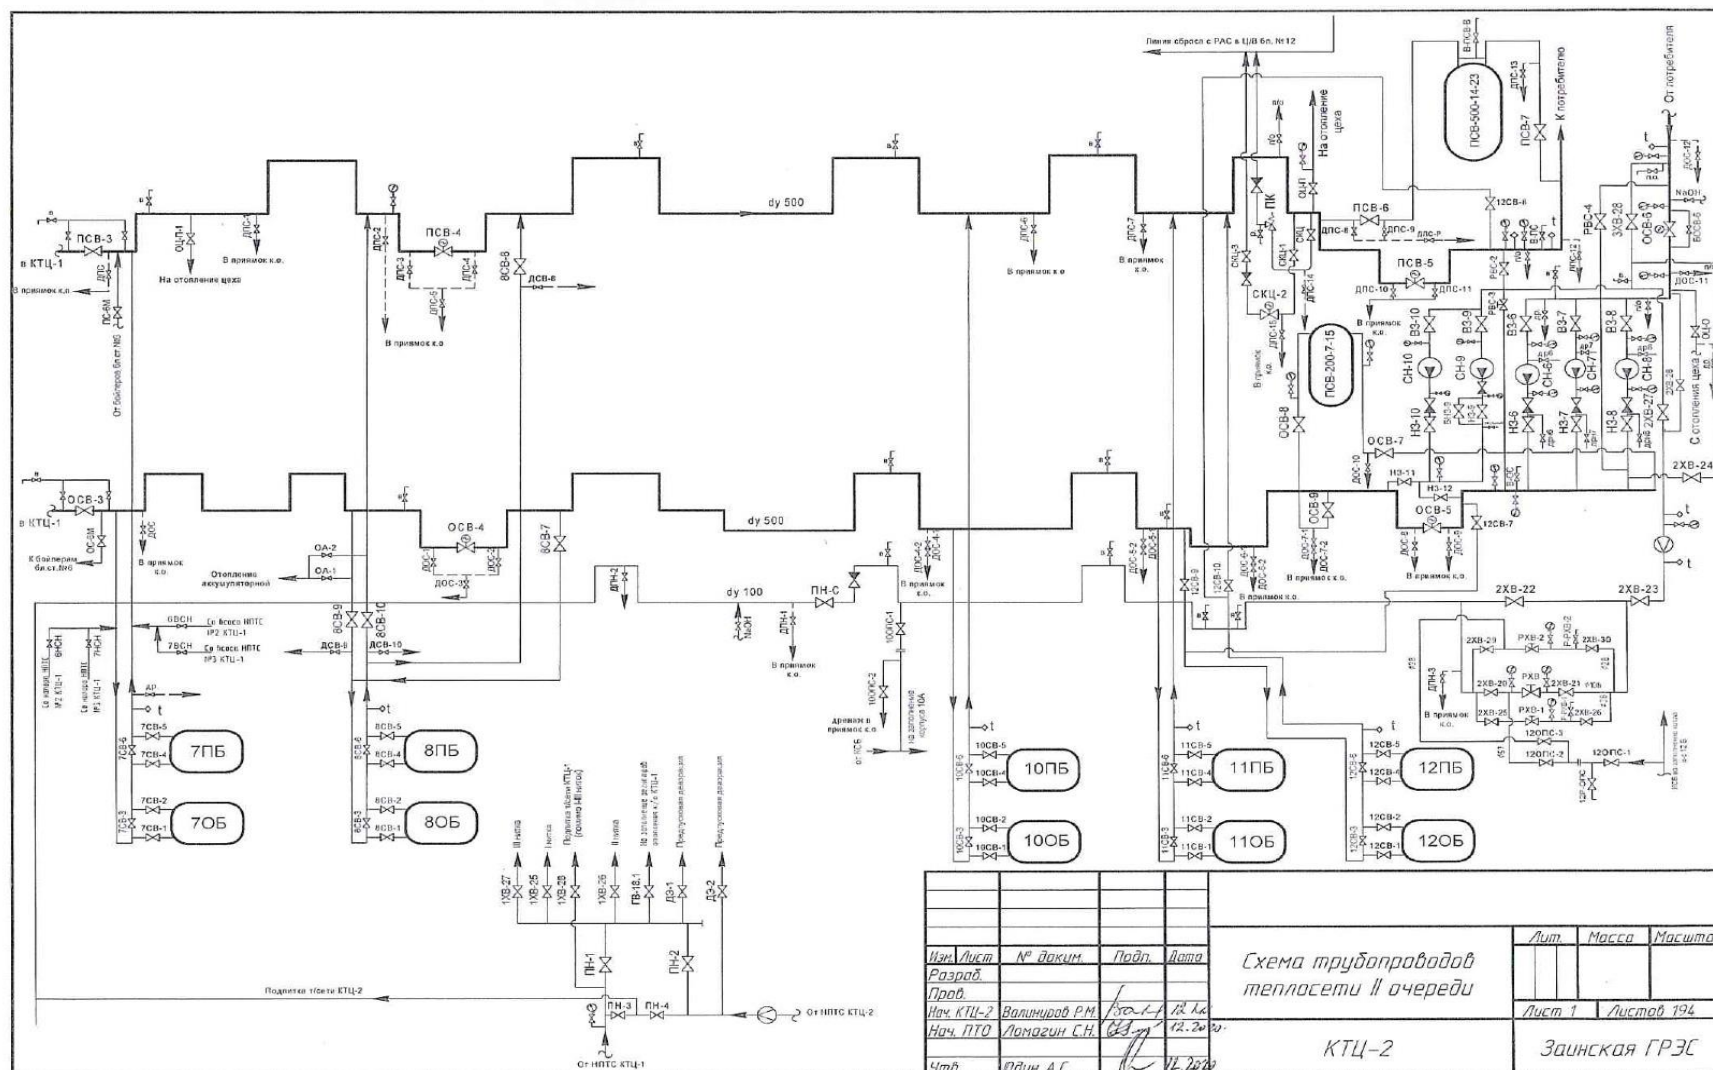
Схема трубопроводов теплосети 2 очереди
